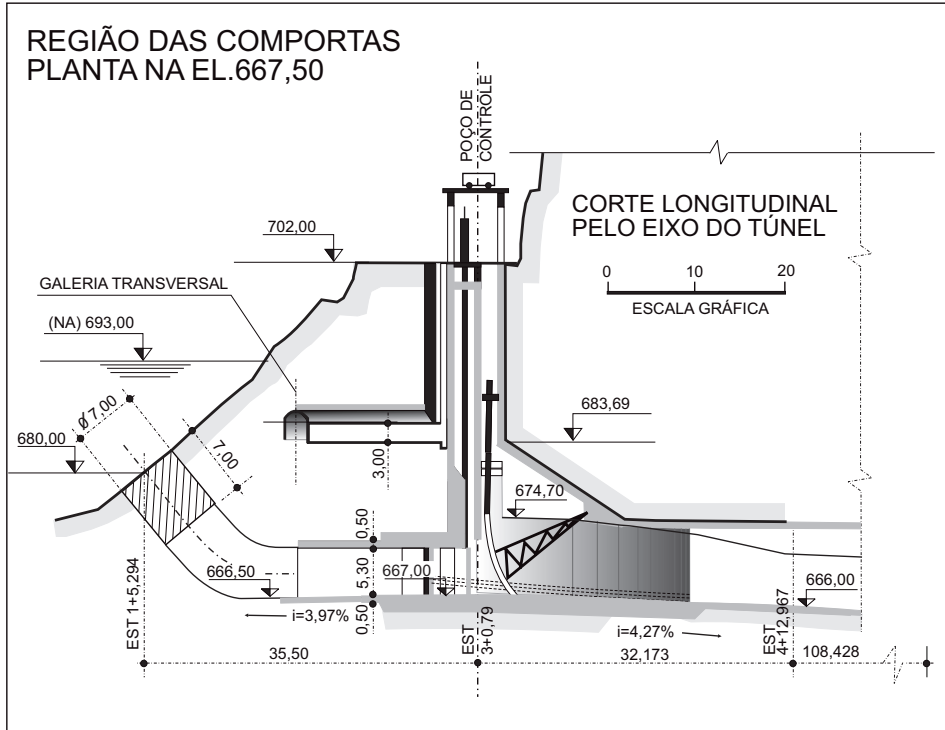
Corte longitudinal pelo eixo do túnel. (Fonte: IPT)
